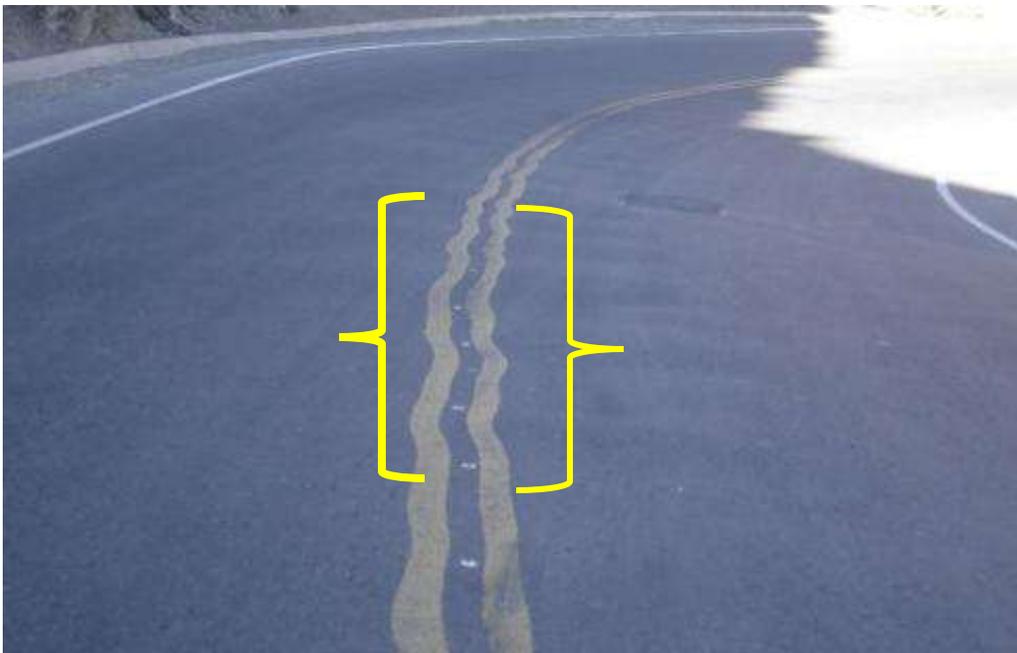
Ondulaciones en un pavimento flexible
